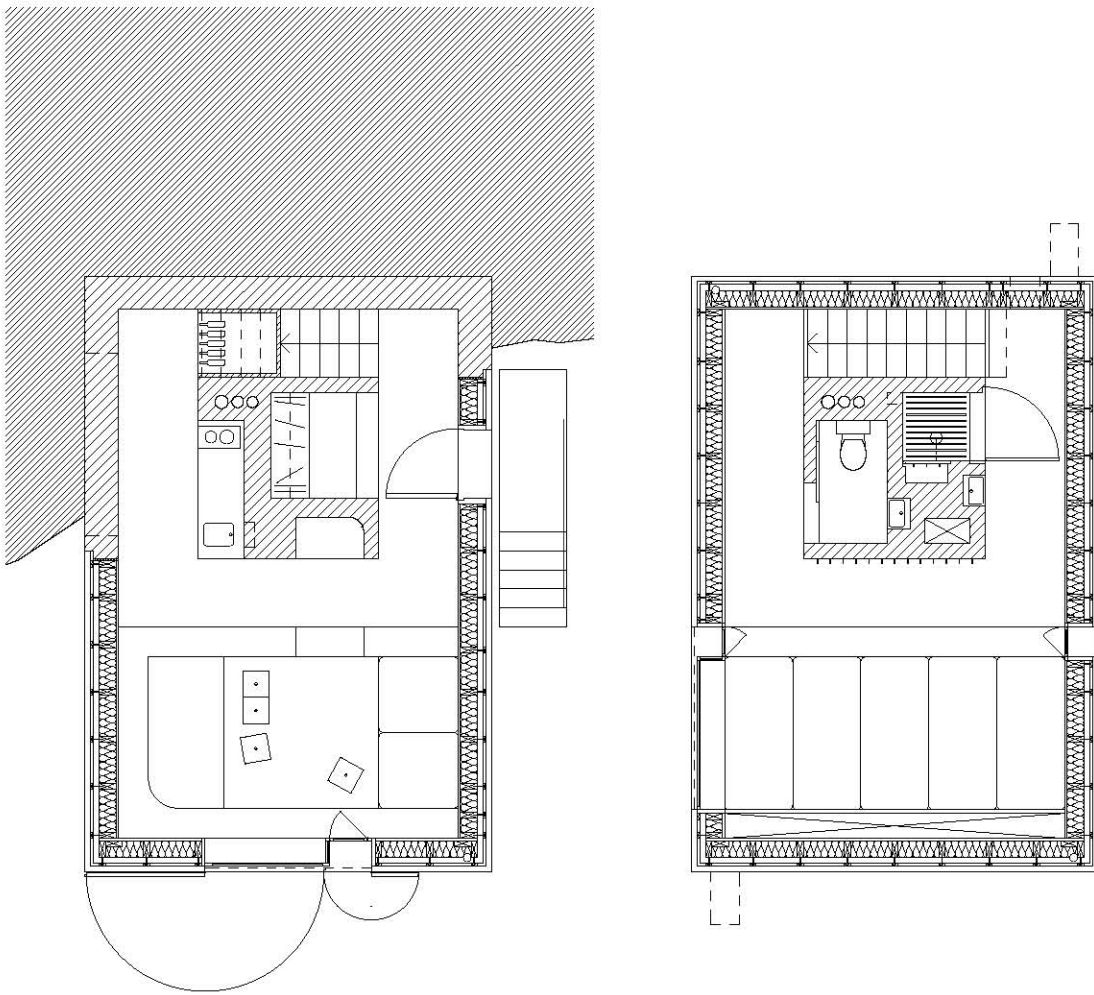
SISTEMA DE PAINÉIS, PLANTAS, ESCALA 1:100.
